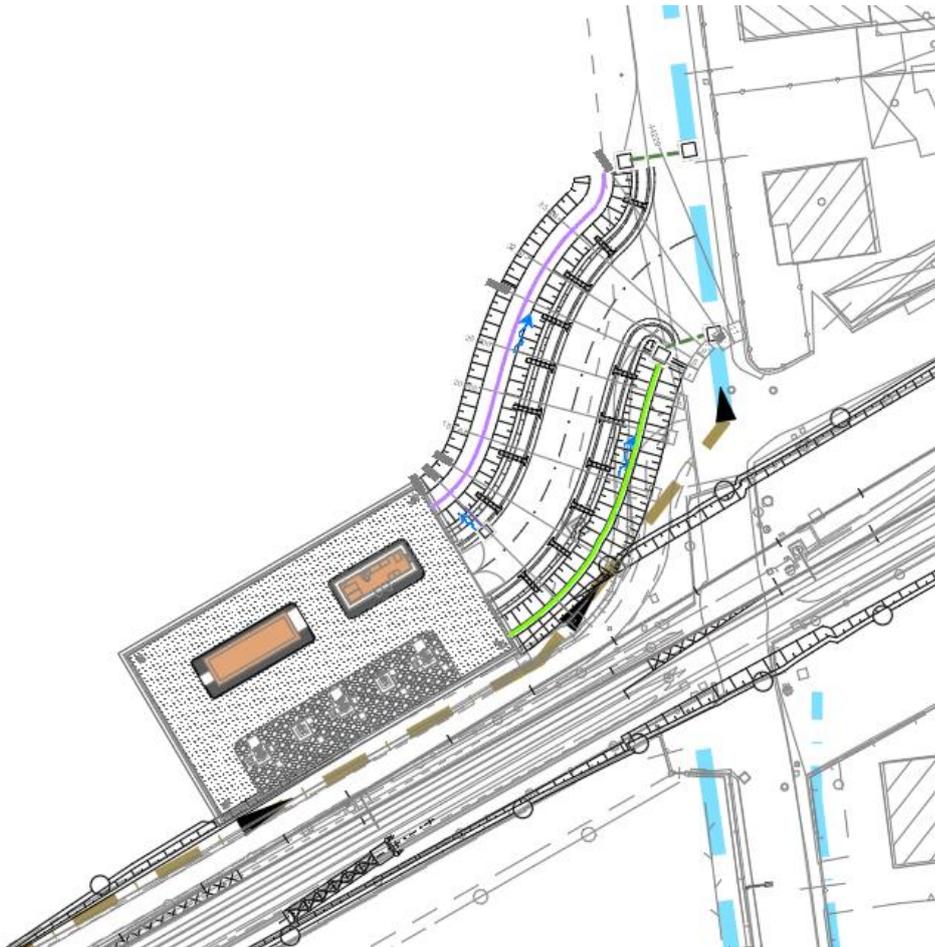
Stralcio planimetrico drenaggio viabilità NV05
